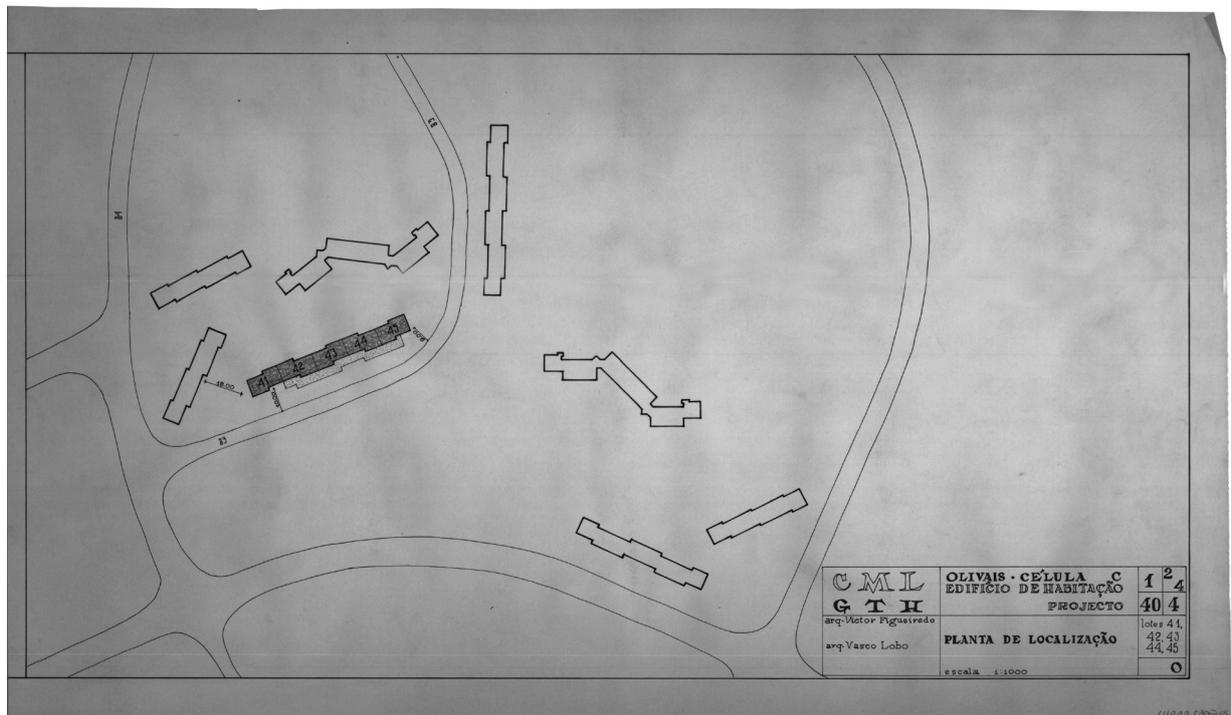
Projeto: lotes 41 a 45, planta de localização
